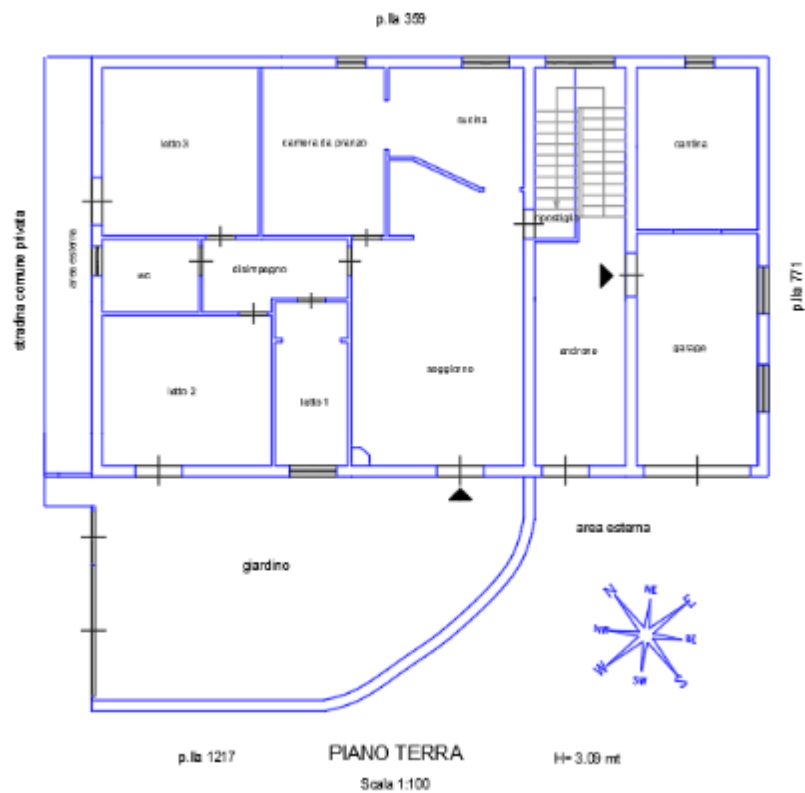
LOTTO 1-planimetria appartamento piano terra
